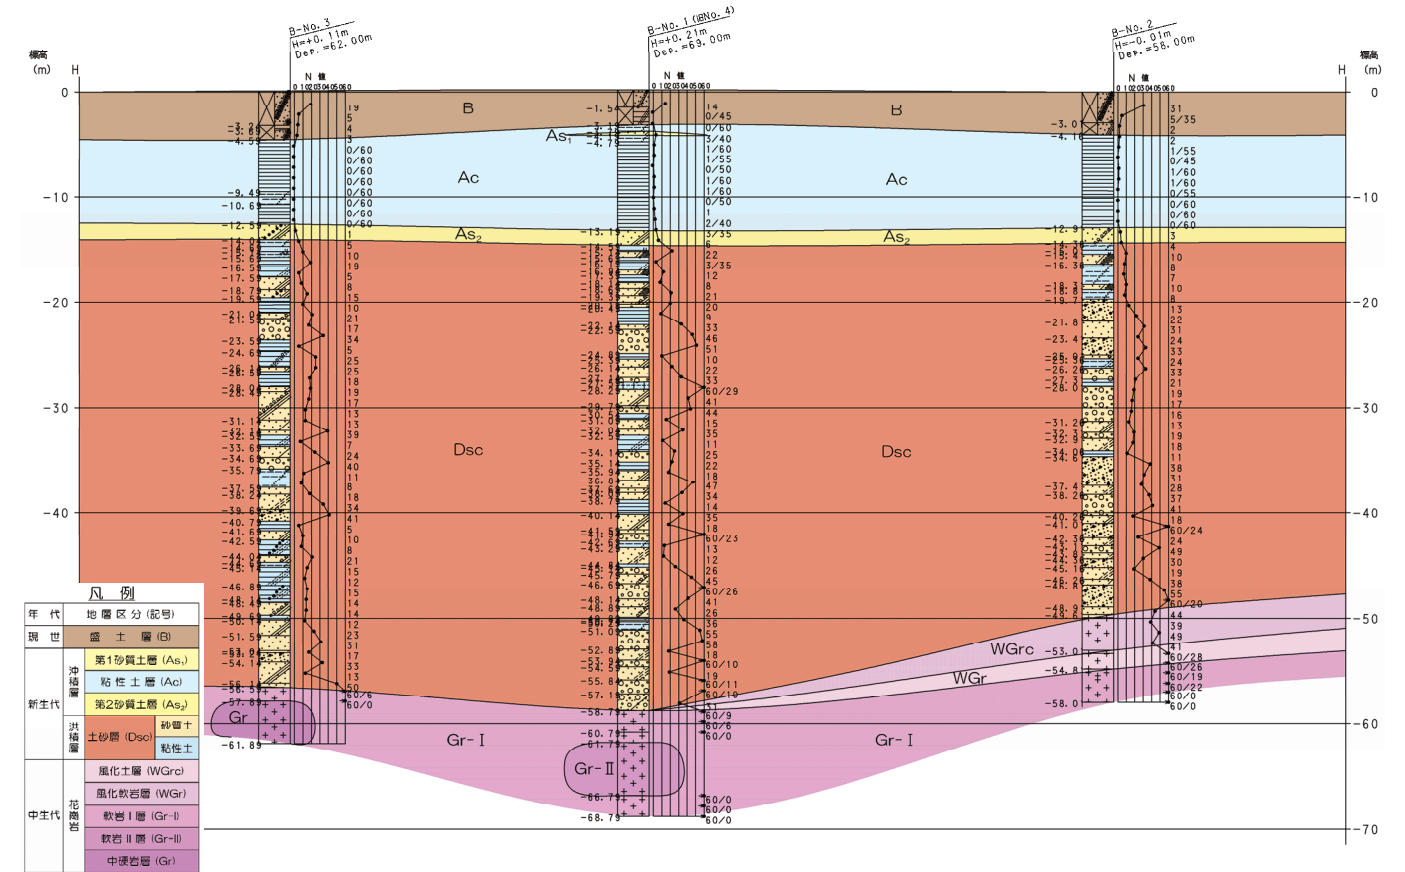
想定土層断面図 (No.3-No.1-No.2)
